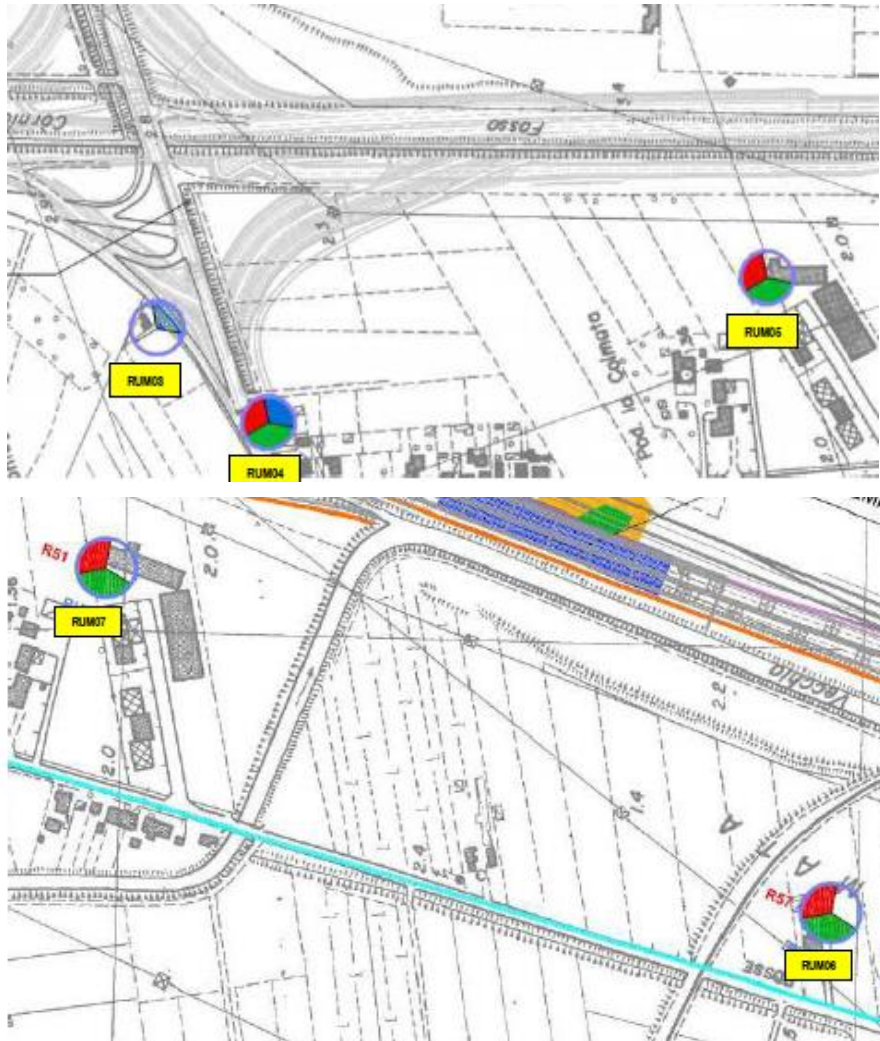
Stralcio Planimetria stazioni di monitoraggio rumore (RUM)
